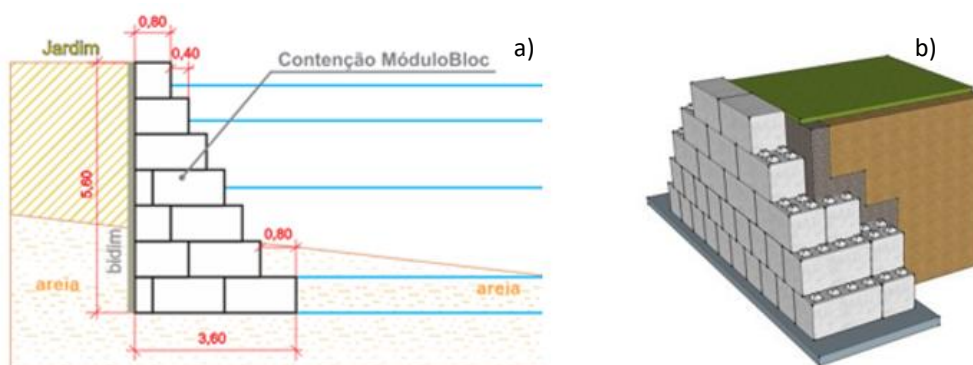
Sistema BetonBloc a) perfil transversal b) perspectiva.
